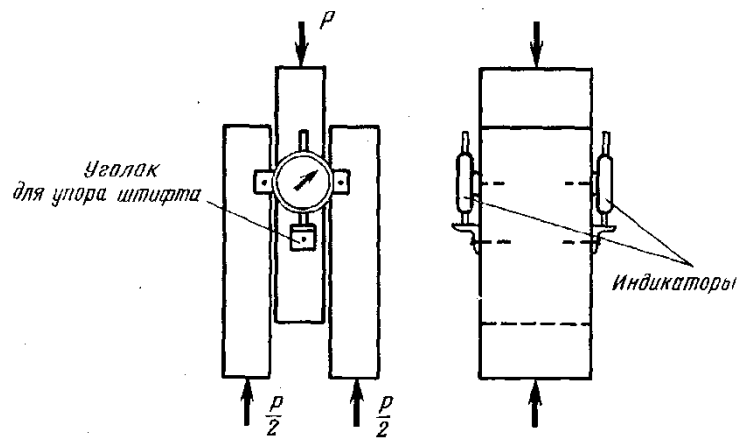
Схема испытания образца соединения на гвоздях и расстановка приборов
